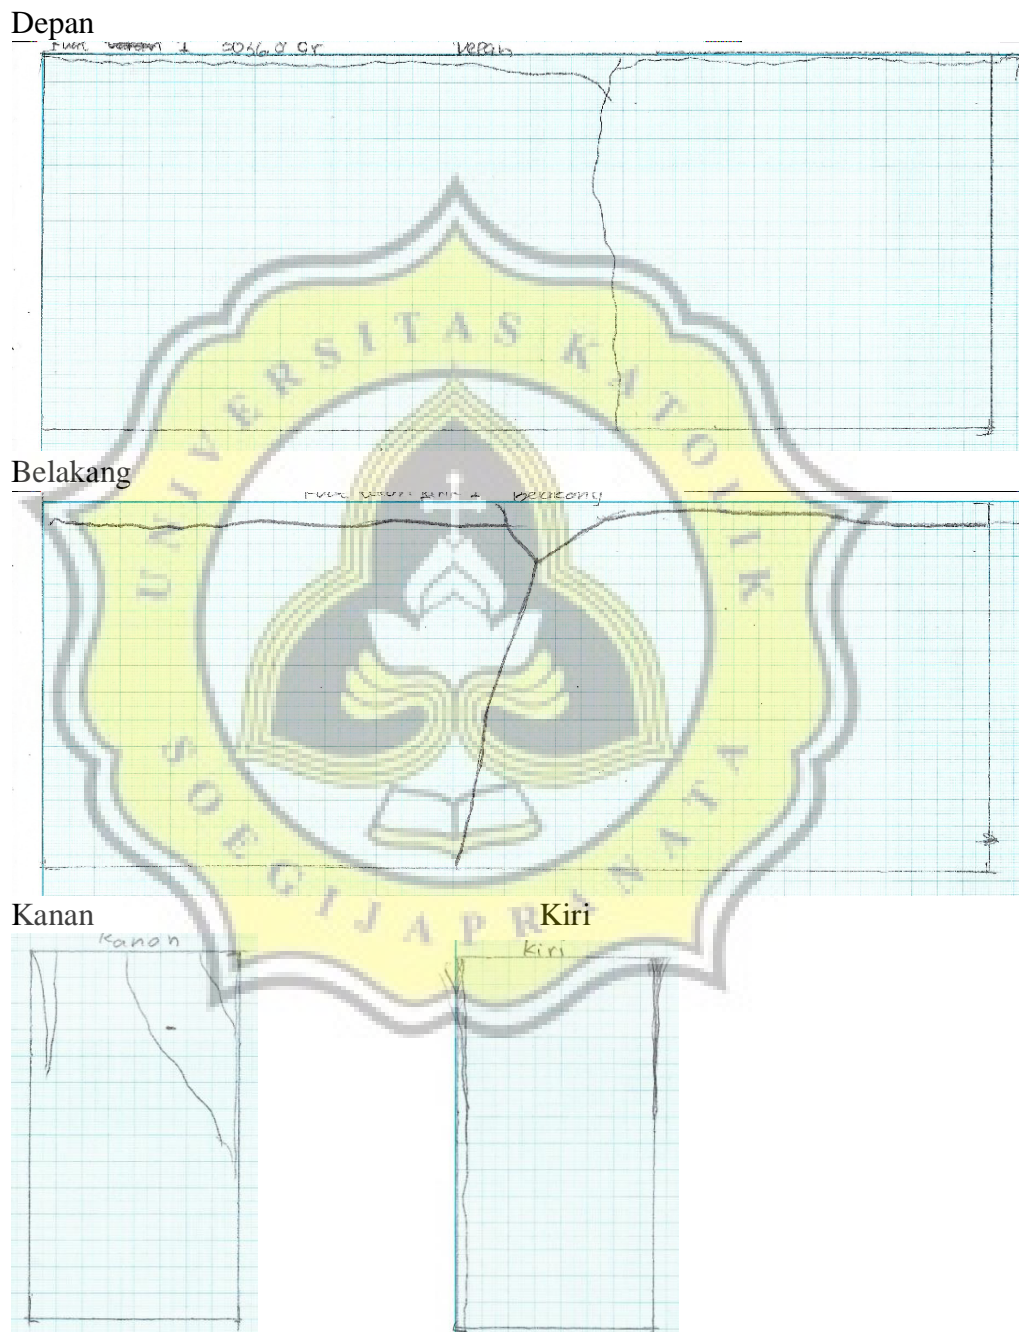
Penurunan permukaan blok beton benda uji KT-SC-05
